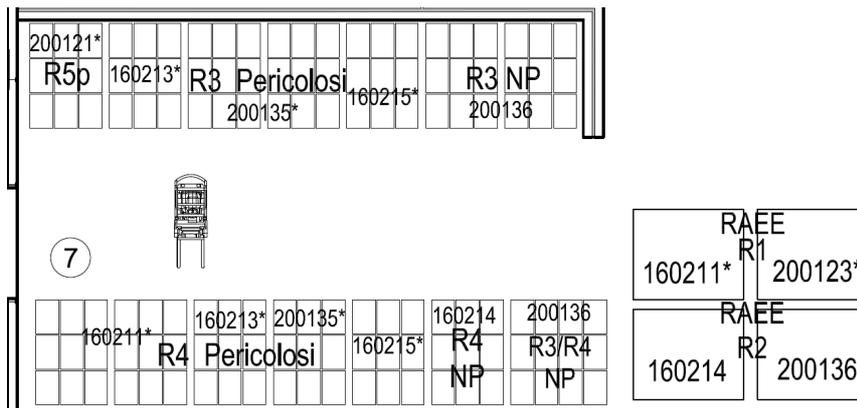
Straccio planimetrico relativo alle aree di stoccaggio dei RAEE
